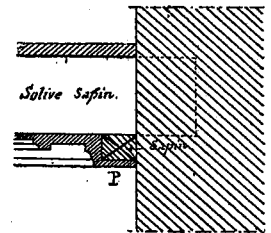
Coupe suivant EF du plan (fig. 317).
